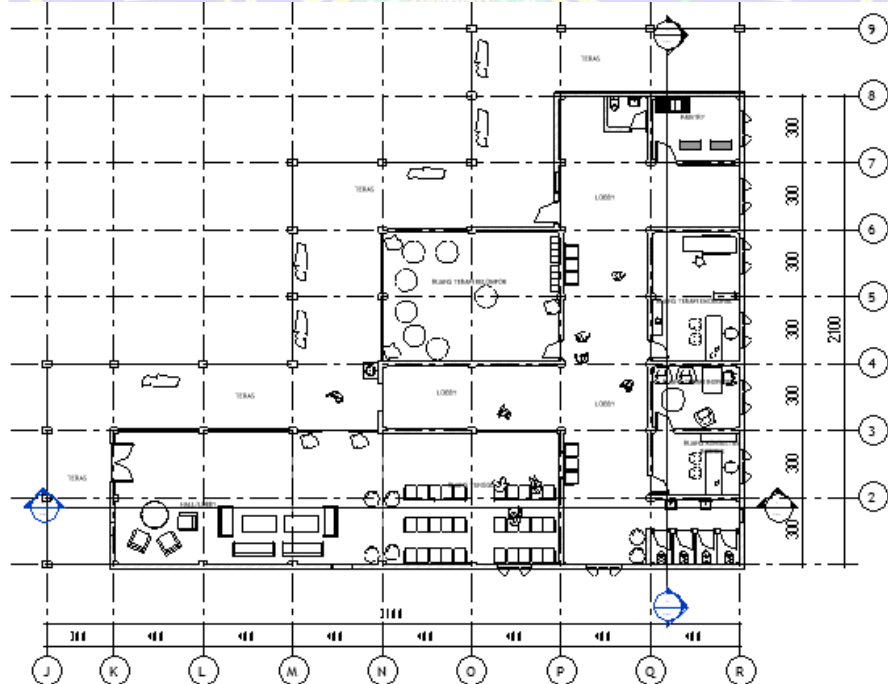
Denah Gedung Pengelola Lantai 2
